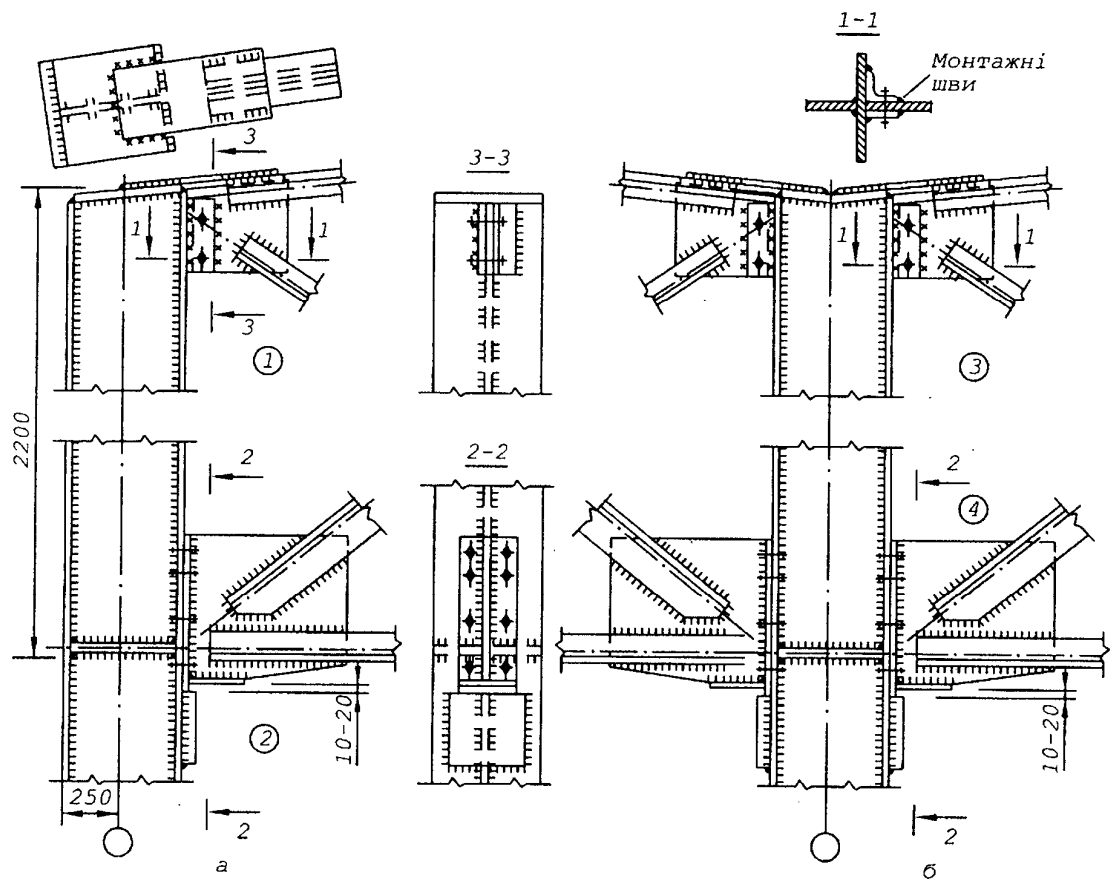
Опорні вузли з прикріпленням ферм до колони збоку:
